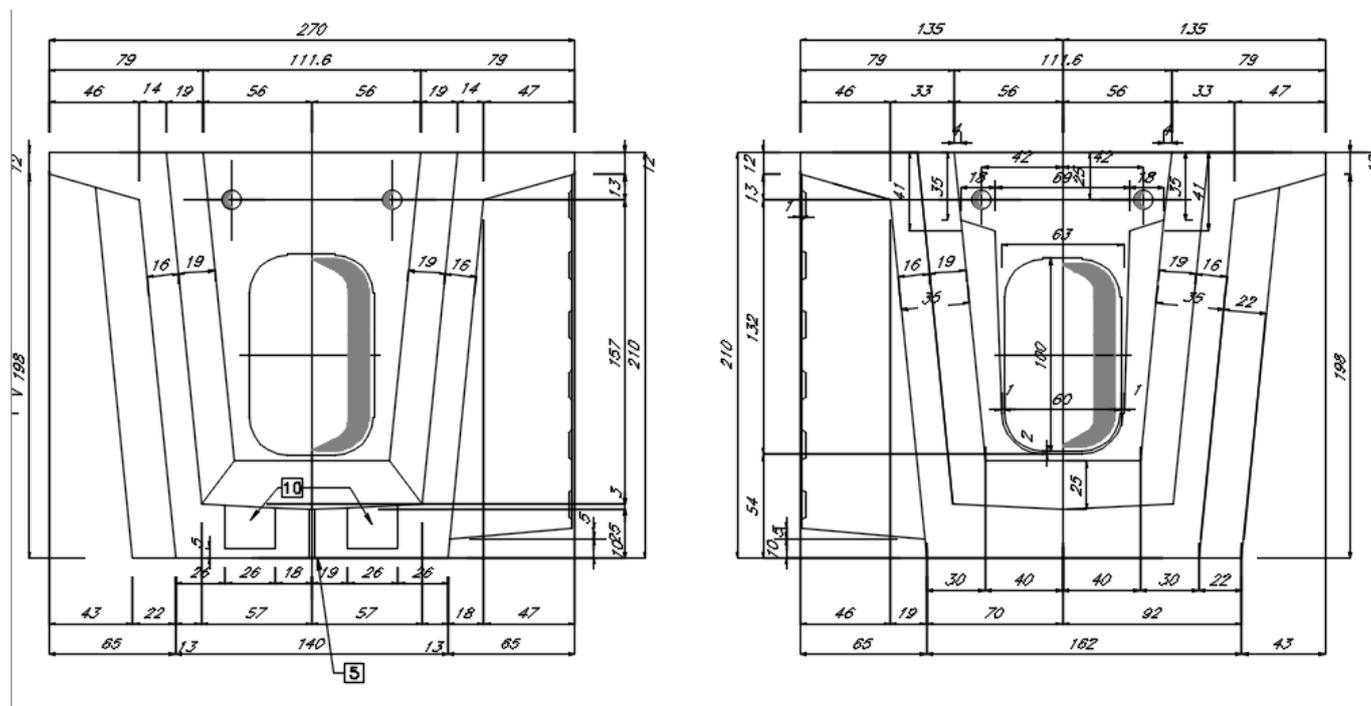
Sezione tipica trasversale dell'impalcato
